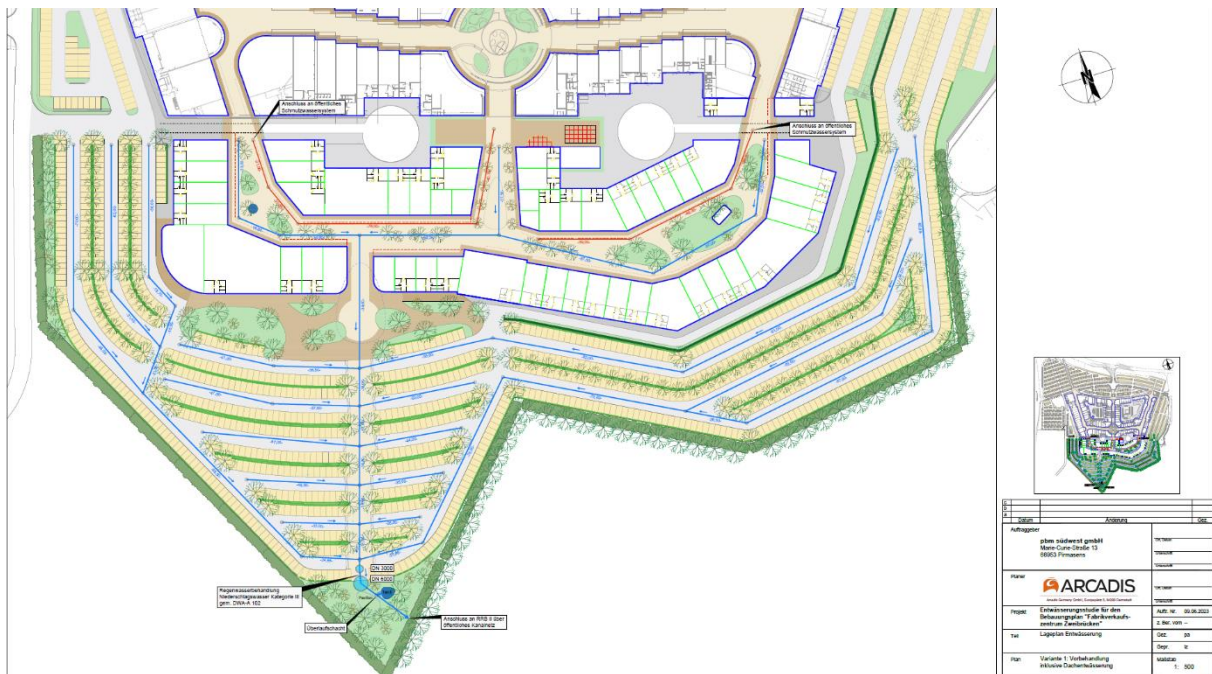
Lageplan Entwässerung: Variante 1: Vorbehandlung inklusive Dachentwässerung (ARCADIS, 2023; vgl. Anlage 18).
